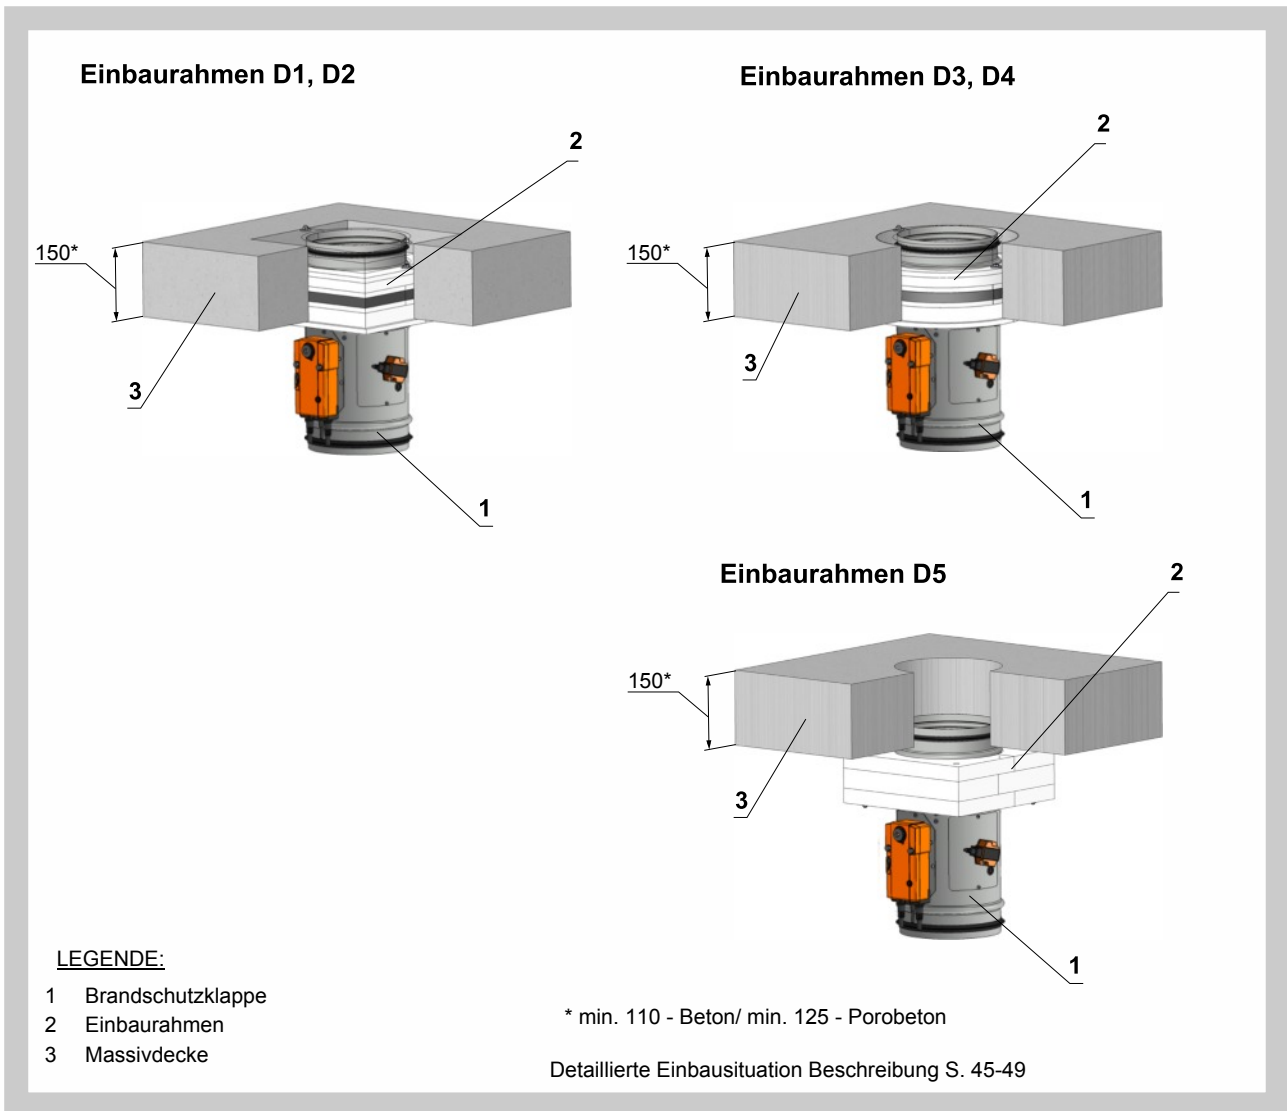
Massivdecken - Trockeneinbau - Weichschott
